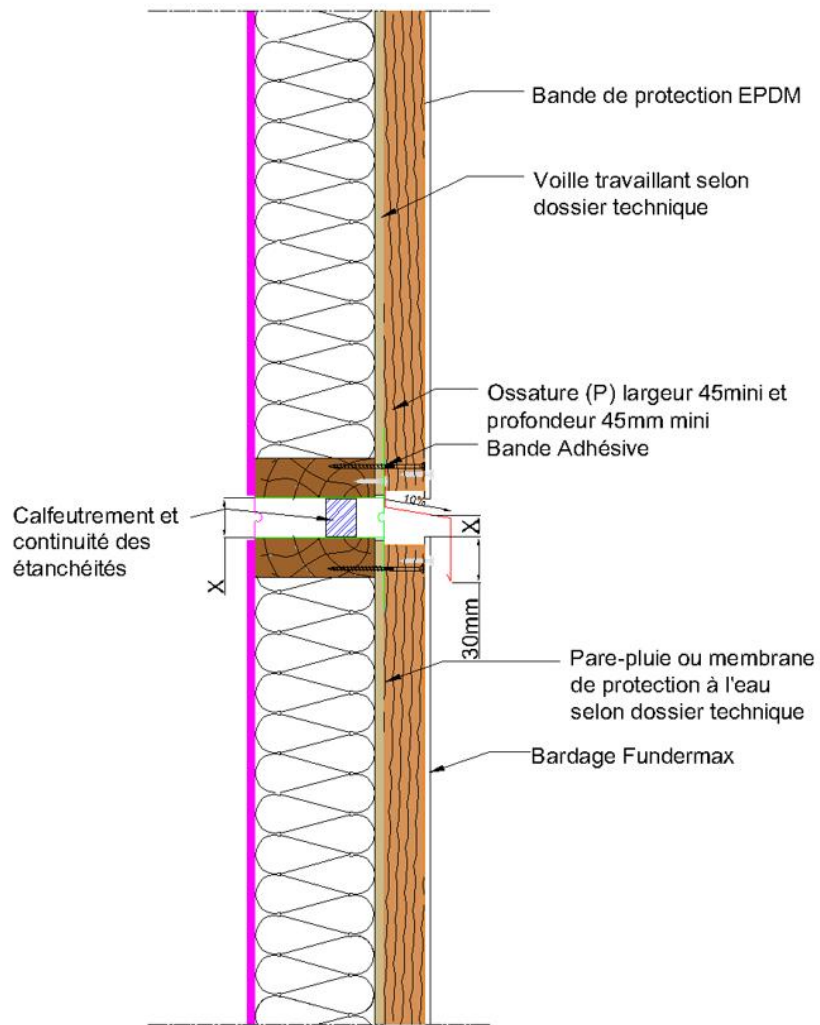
Jeu fonctionnel horizontal Ee2, coupe verticale
